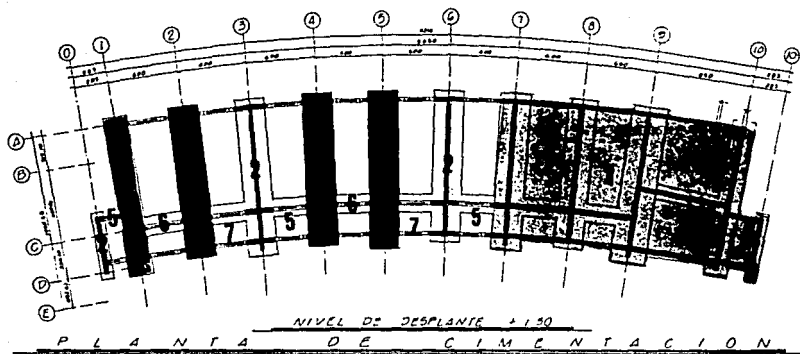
SECUENCIA DE CONSTRUCCION DE ZAPATAS DE CIMENTACION.
